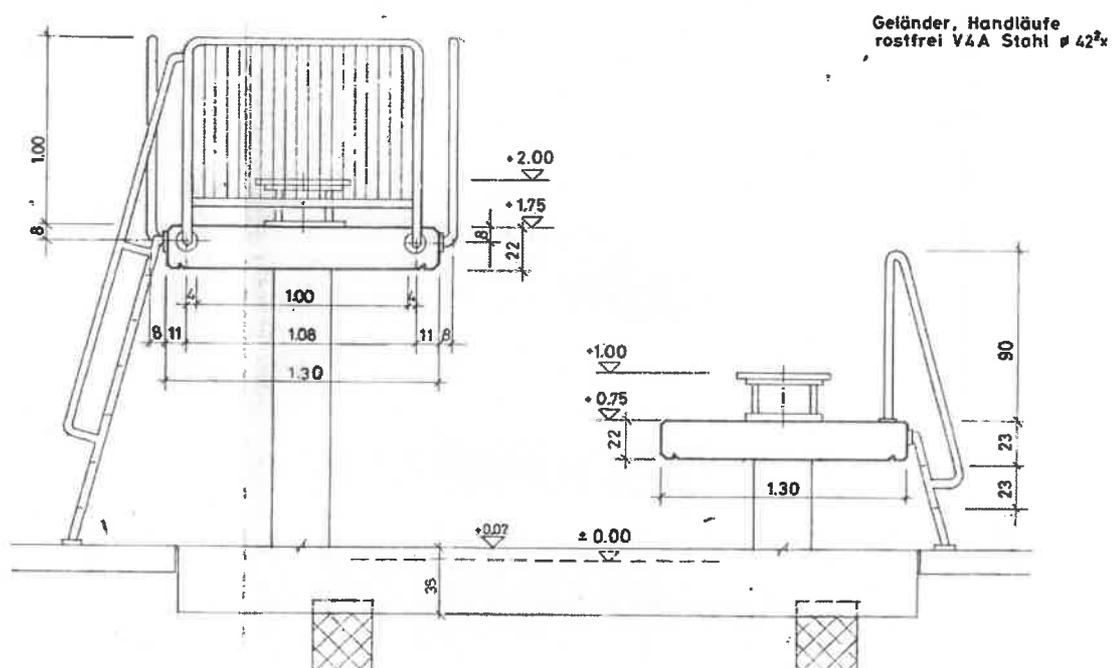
Konstruktionsplan Sprunganlage Projekt 1992.
